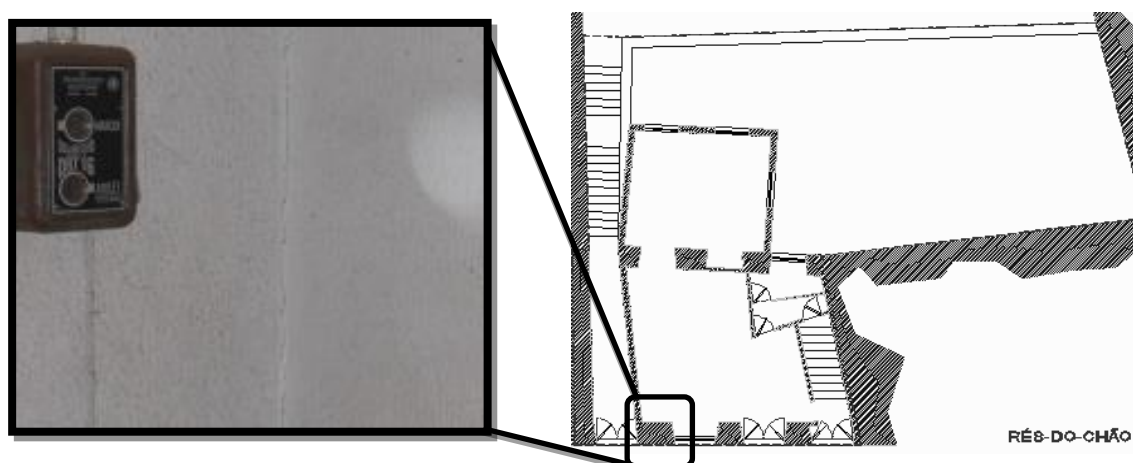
Anomalia 7 - Fotografia e localização em planta
